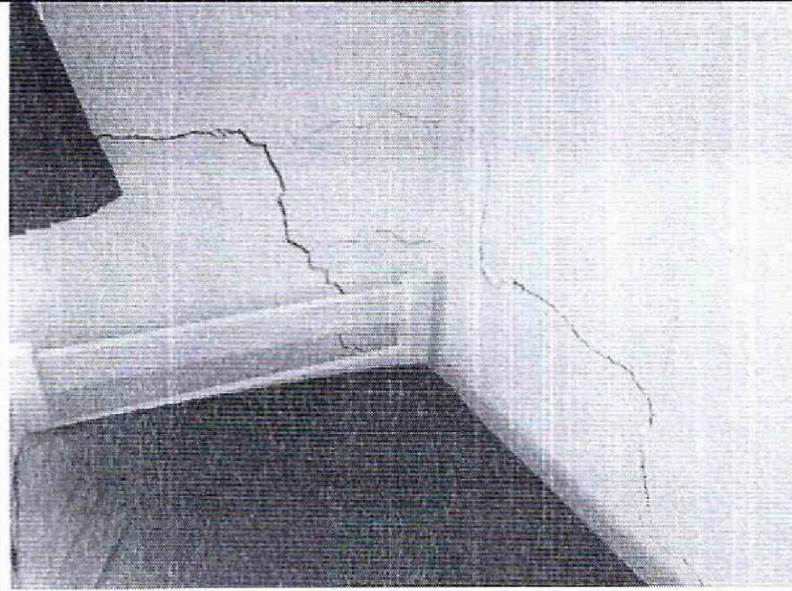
Grieta en vértice del muro del sector noroccidental.
